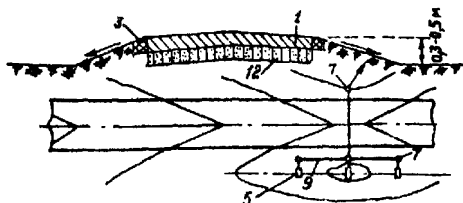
Схемы водоотводных и дренажных сетей аэродромных покрытий :
